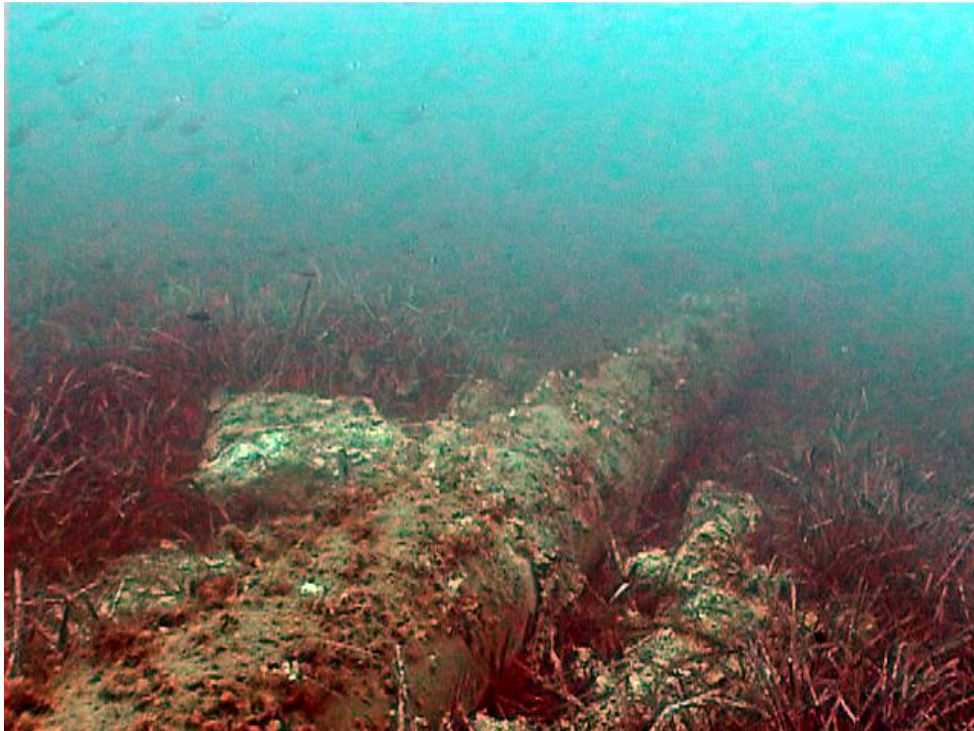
Cota -19 m. Pila de sacos con dos bloques sobre ellos
